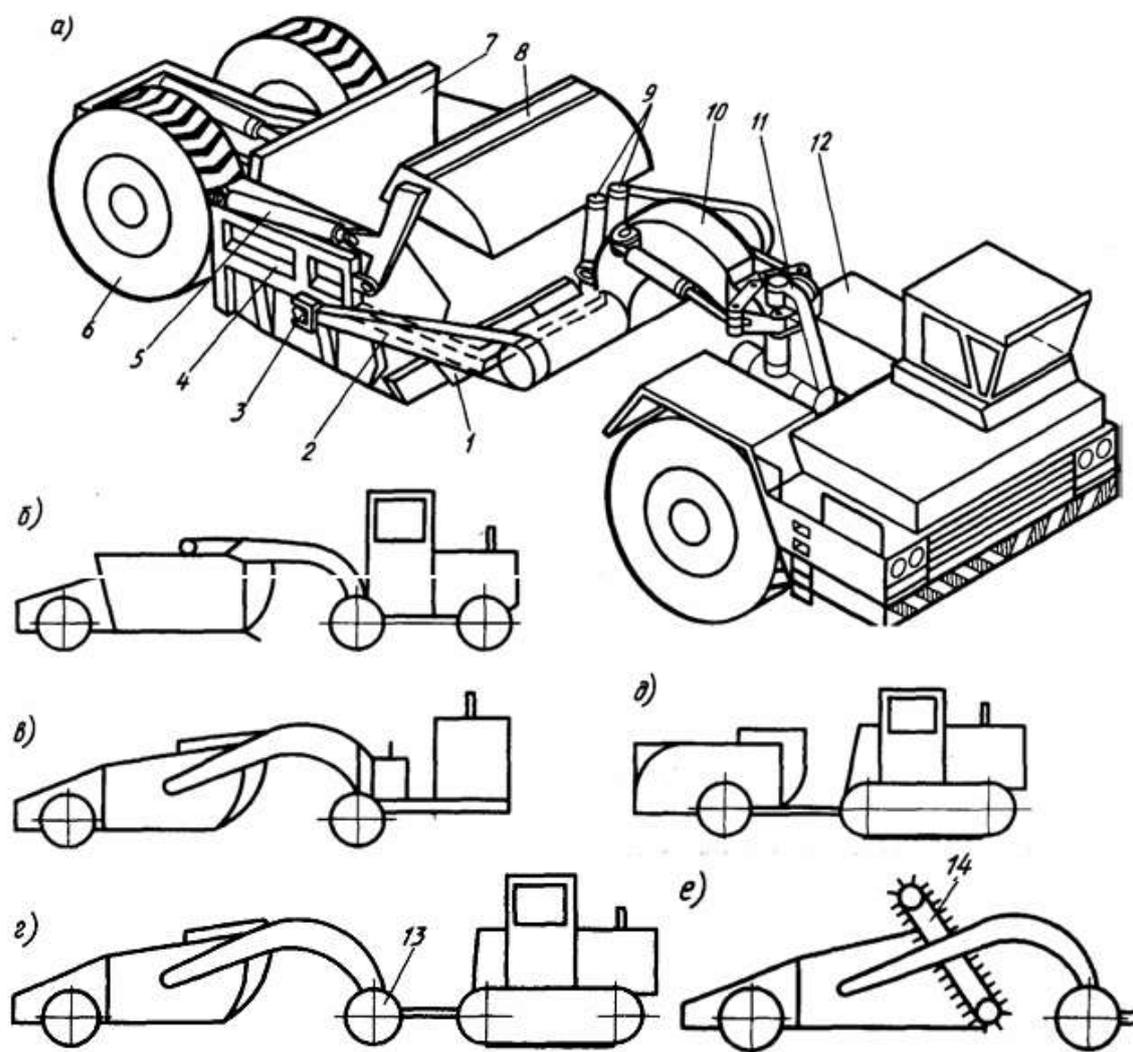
Самоходный скрепер (а), схемы соединения с тягачом (б...д), скрепер с принудительной загрузкой ковша скребковым элеватором (е): 1– нож; 2– боковая балка; 3– упряжный шарнир; 4– ковш; 5, 9– гидроцилиндры; 6– заднее колесо; 7– задняя стенка ковша; 8– заслонка; 10– передняя балка; 11– универсальный шарнир; 12– тягач; 13– тележка; 14– скребковый элеватор.
